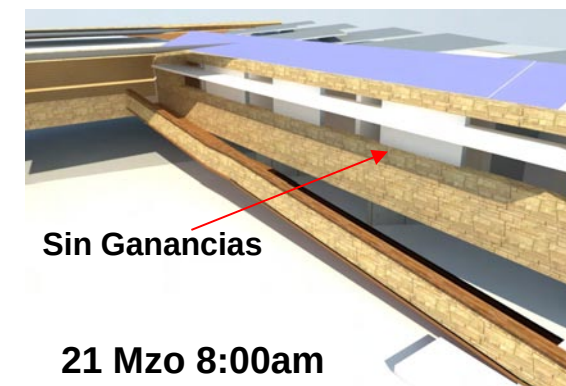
Estudio de asoleamiento Fachada Norte Y Fachadas interiores.
